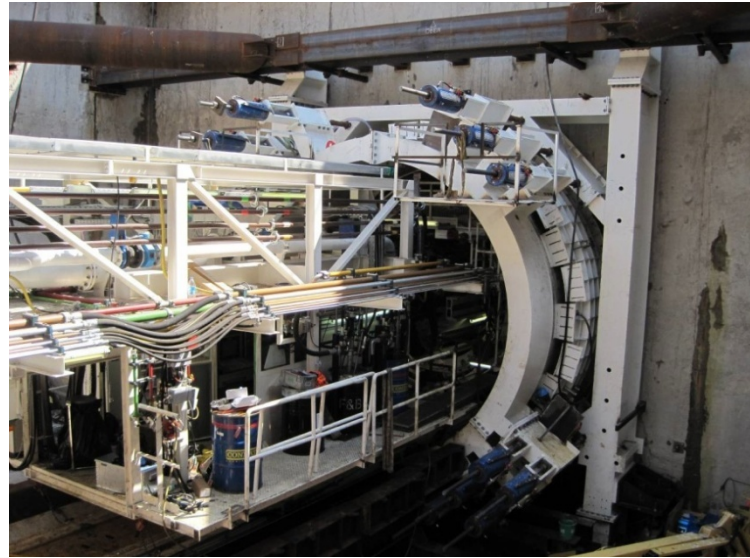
Stahlbau Rückverankerung nach der Anfahrt
